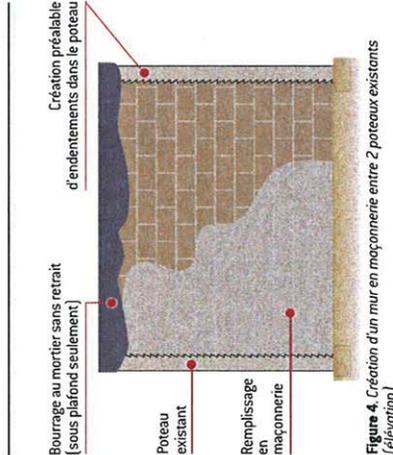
Création d'un mur en maçonnerie entre 2 poteaux existants (élévation)
